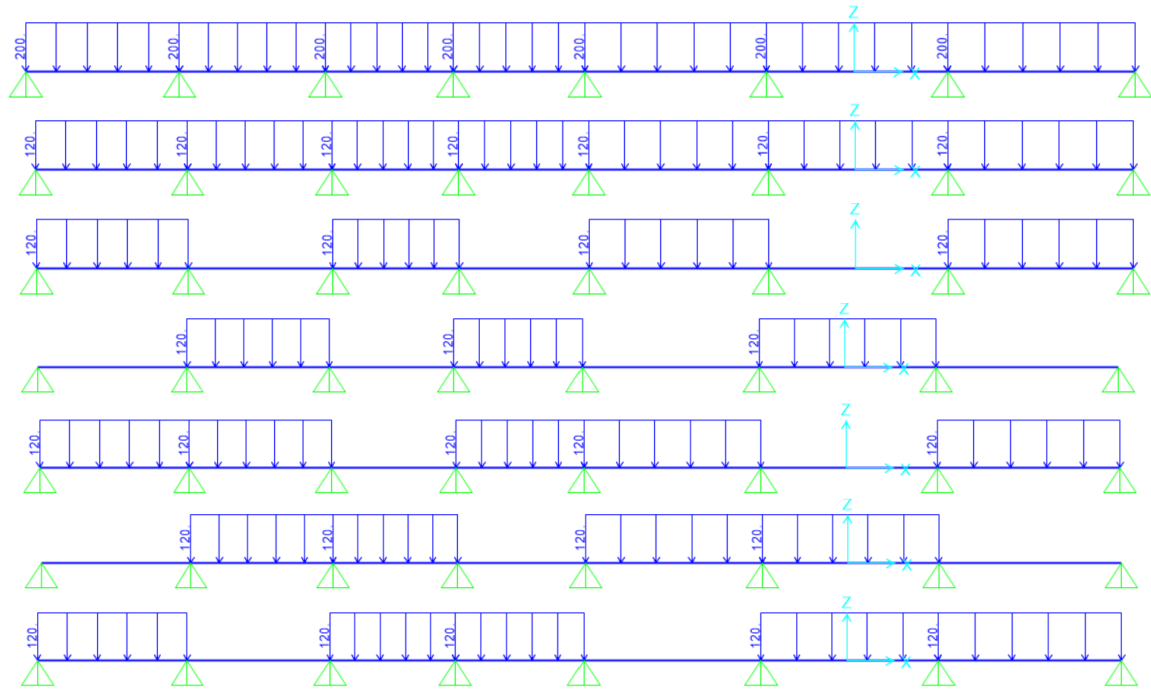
Estados de cargas consideradas en el diseño de losas aligeradas (kgf/m)
